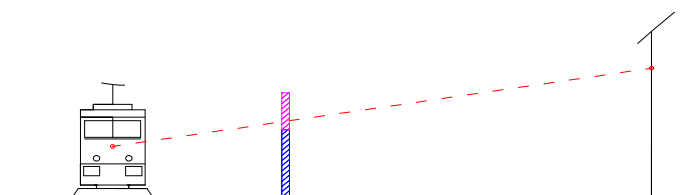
Croquis vista alçat situació pantalla prevista.
